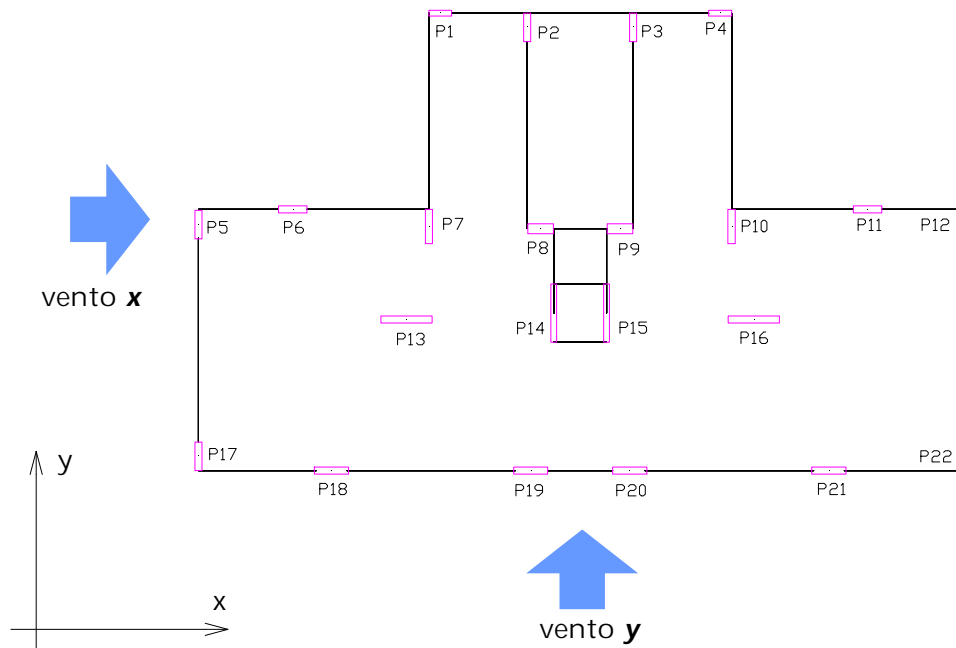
Esquema de aplicação das ações horizontais ao pórtico do ed. Maison Versailles.
